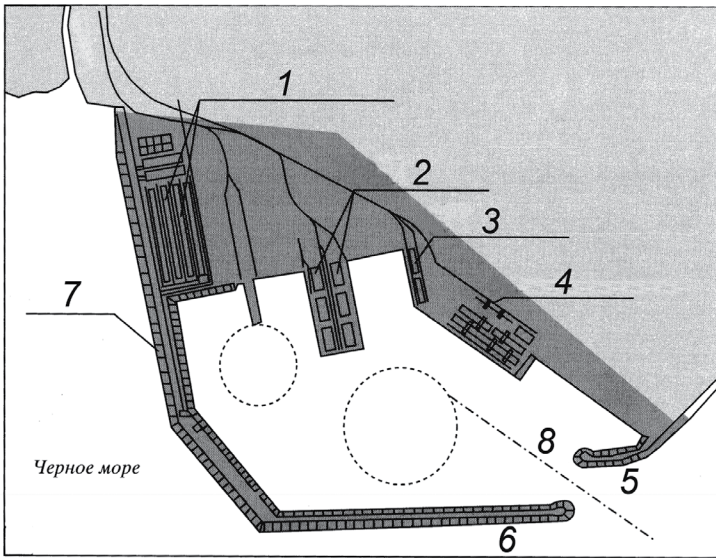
Морской порт вдоль приглубого берега, с характерными элементами и сооружениями: 1 – открытые складские площадки насадочных групп; 2 – район генеральных грузов крытого крепления; 3 – район генеральных грузов открытого крепления; 4 – контейнерный терминал; 5 – Южный оградительный мол; 6 – Северный оградительный мол; 7 – берегоукрепление; 8 – ось подходного канала.
